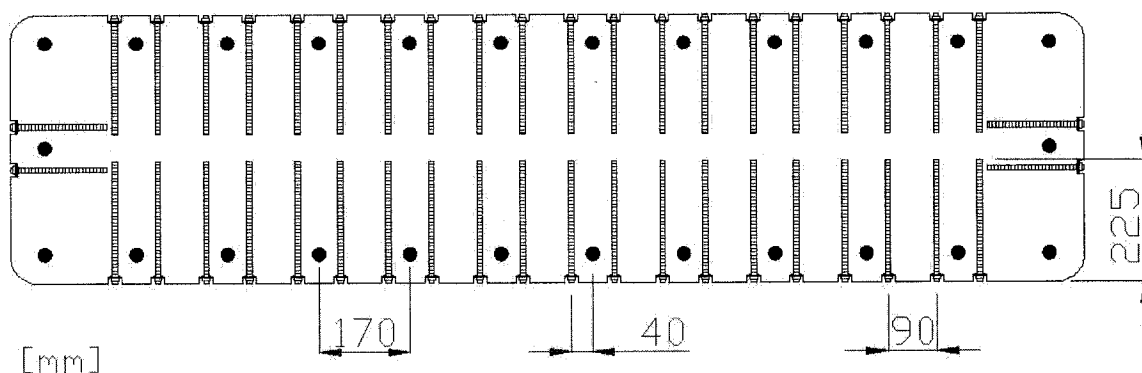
Coupe transversale du renforcement utilisé pour S4
